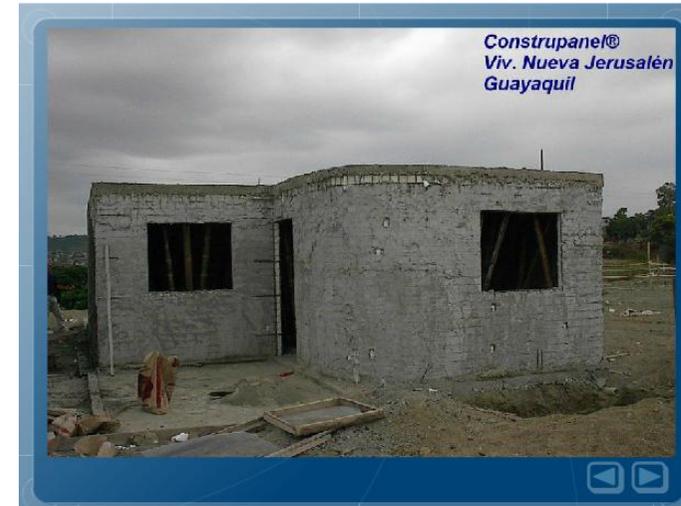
Etapa 3: se finaliza con la colocación del mortero, y se construye vigas de amarre superior.
